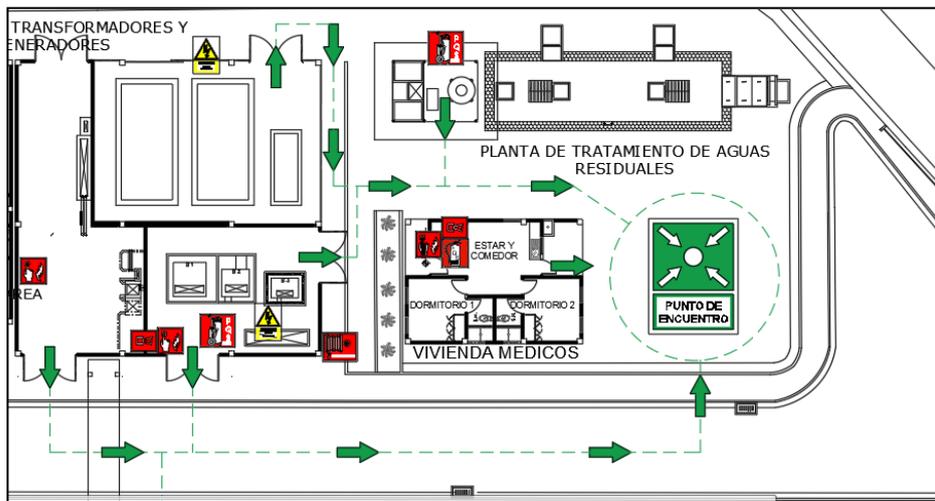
Planos de Evacuación-Planta Baja - área casa de maquinas
